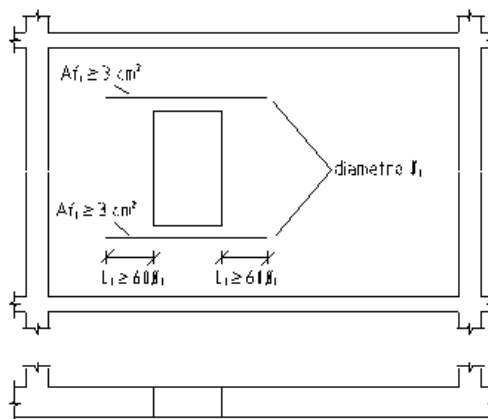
Armatura minima in corrispondenza delle aperture
